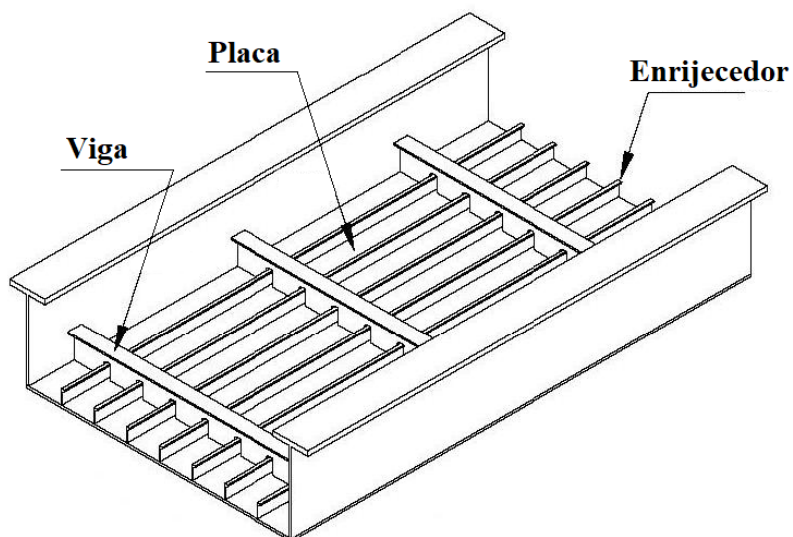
Configuração típica de placa com enrijecedores longitudinais e transversais
